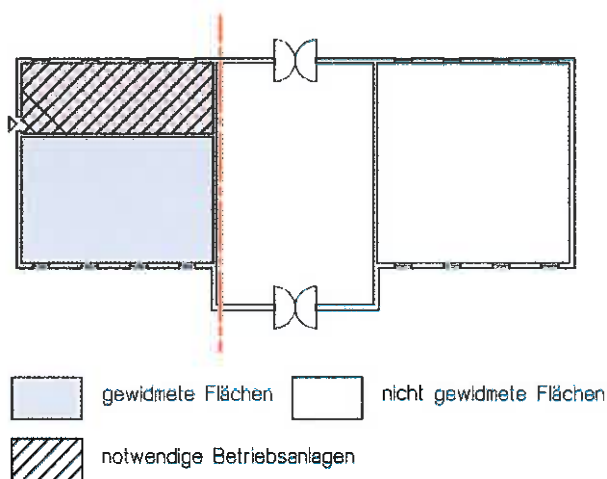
Raum an Außenwand mit Gebäudetrennung
